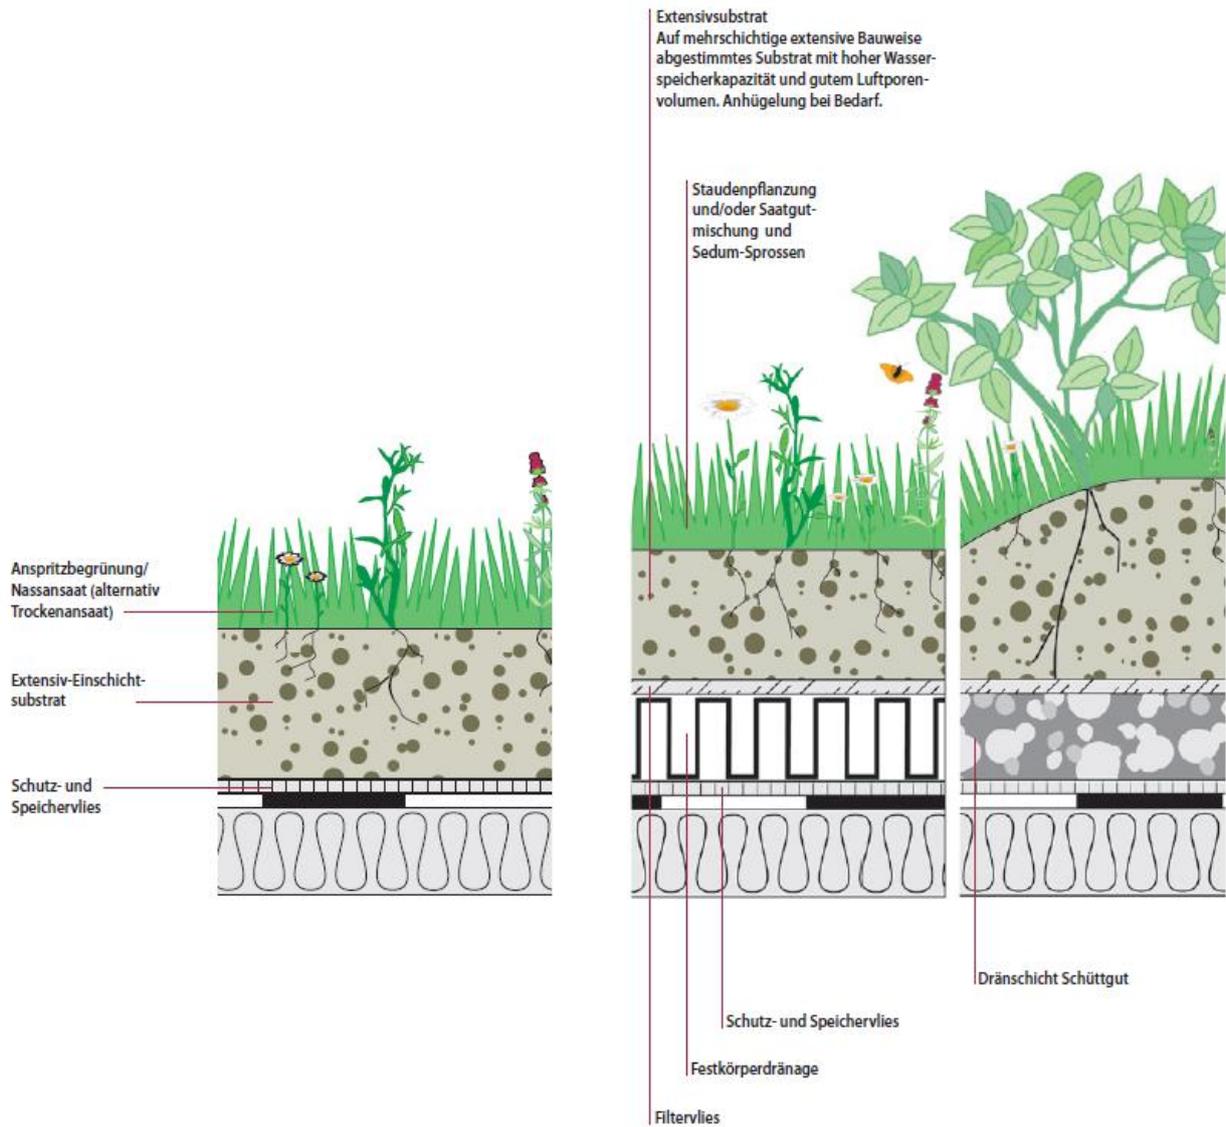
Extensive Dachbegrünung; Quelle: SenStadt (2010)
